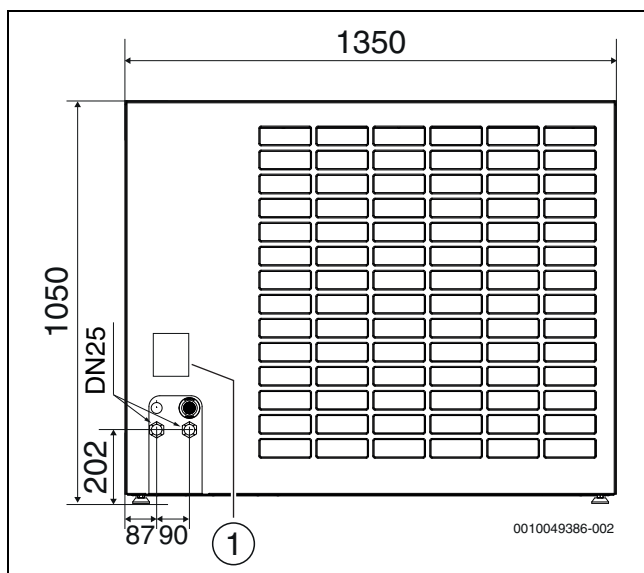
Abmessungen und Anschlüsse, Rückseite (Maße in mm)
